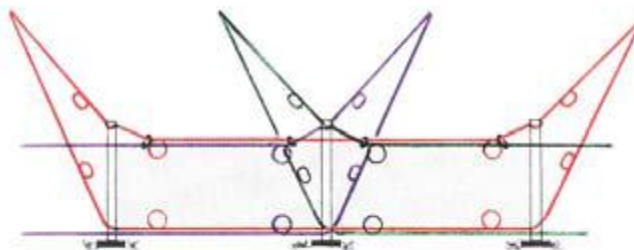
Disposición de los cables en la estructura de la barrera.
